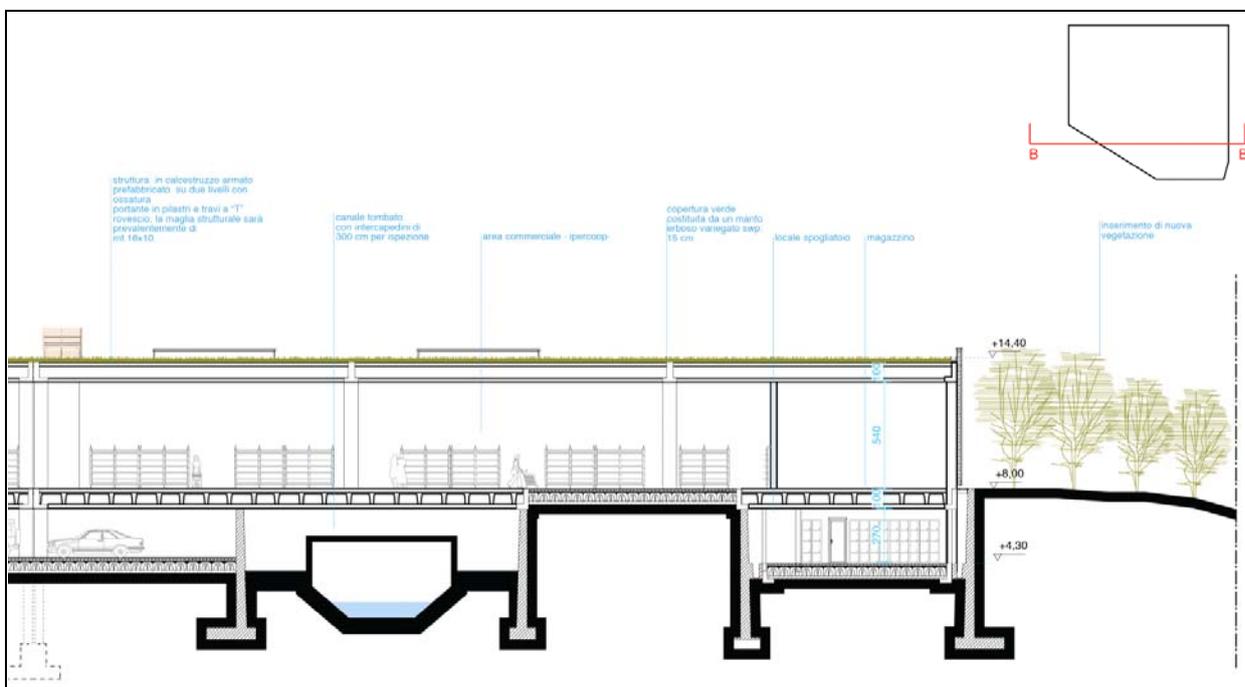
Stralcio sezione edificio C col collettore interno al sedime ell'edificio (Stralcio elaborato AdCSez026 del progetto definitivo architettonico)
